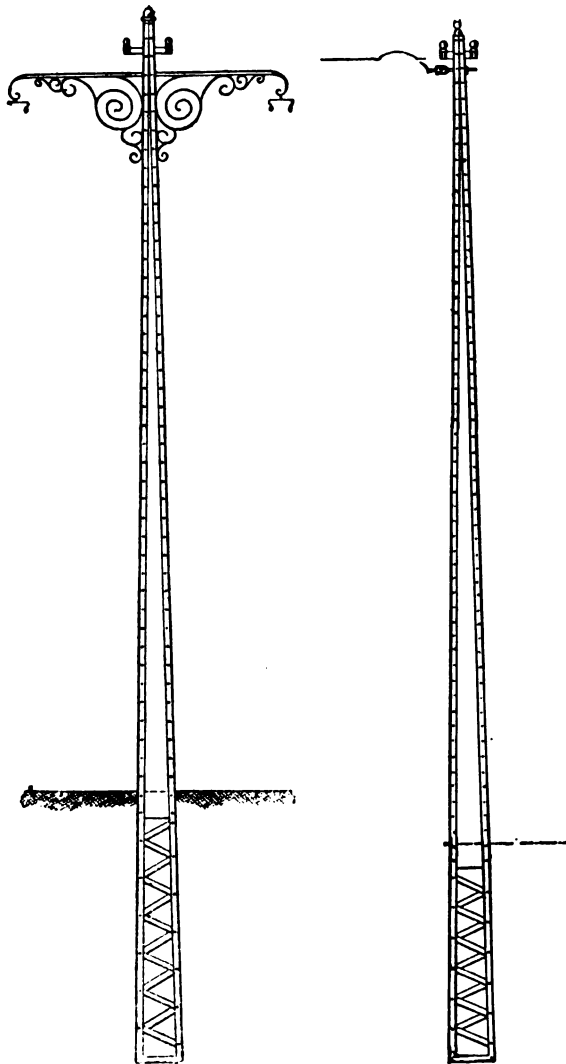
et 99. — Poteaux à potence de la Berlin Iron Bridge Co.
